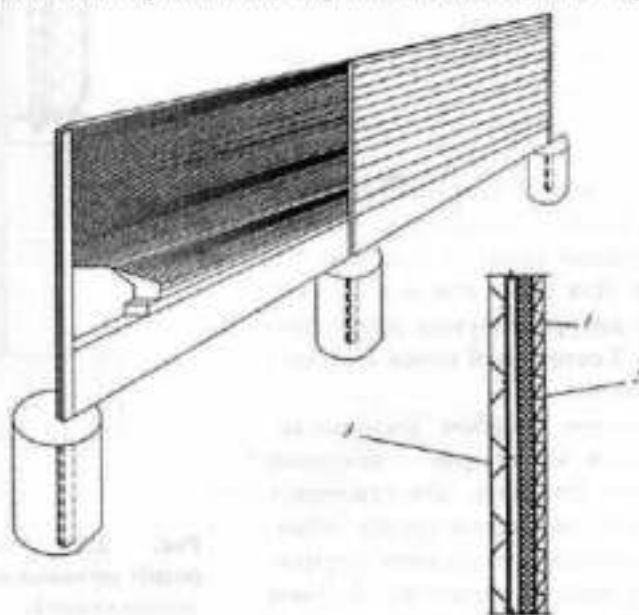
Загальний вид і конструктивний розріз шумопоглинаючого металевого екрану:
